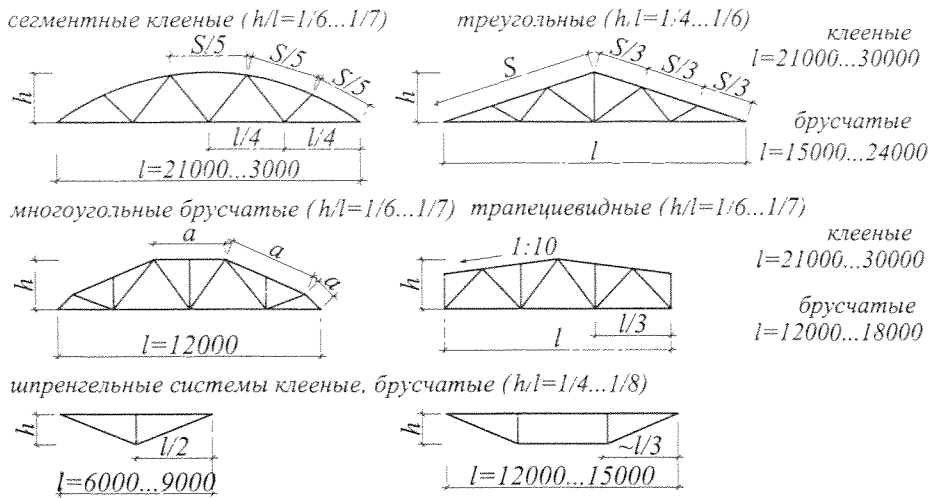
Примеры типовых деревянных стропильных ферм
